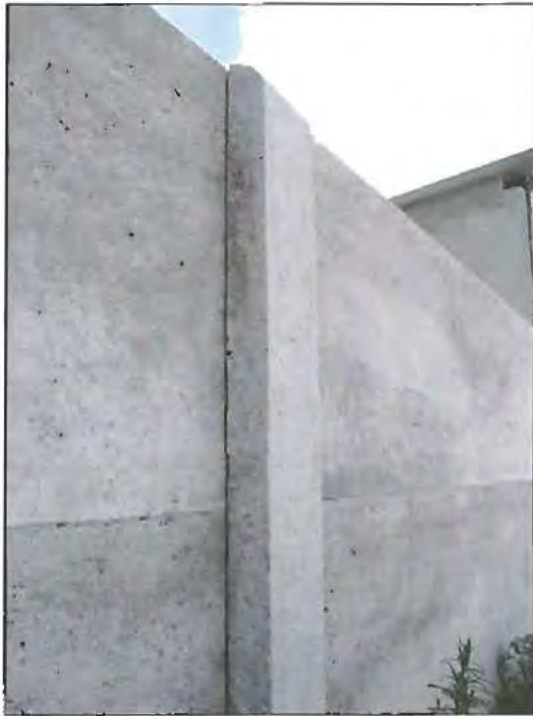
Detalle del encuentro del pilar con la placa pandereta desprovista del remate con mortero que asegura la inmovilidad de dichos elementos.
